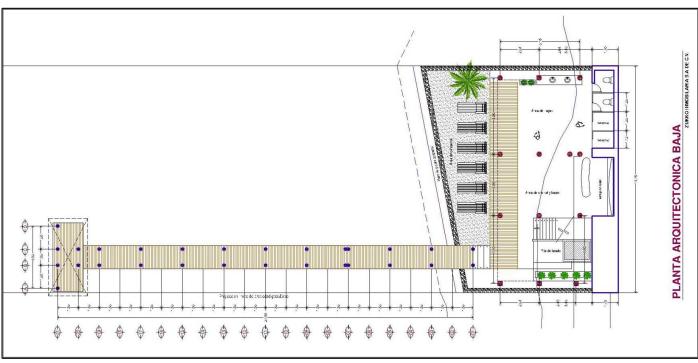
A. Planta general del proyecto "Club de Playa Zukko". Medio terrestre (ZOFEMAT): murete, área para resguardo de kayak, área para equipó de buceo y snorkel, pileta de enjuague, vestidores y baños, área de playa para camastros, deck de madera desmontable y arranque de muelle rustico de madera. Medio marino (Mar Caribe): Muelle rústico de madera (Ver en Anexos: Planos Arquitectónicos del Proyecto).
